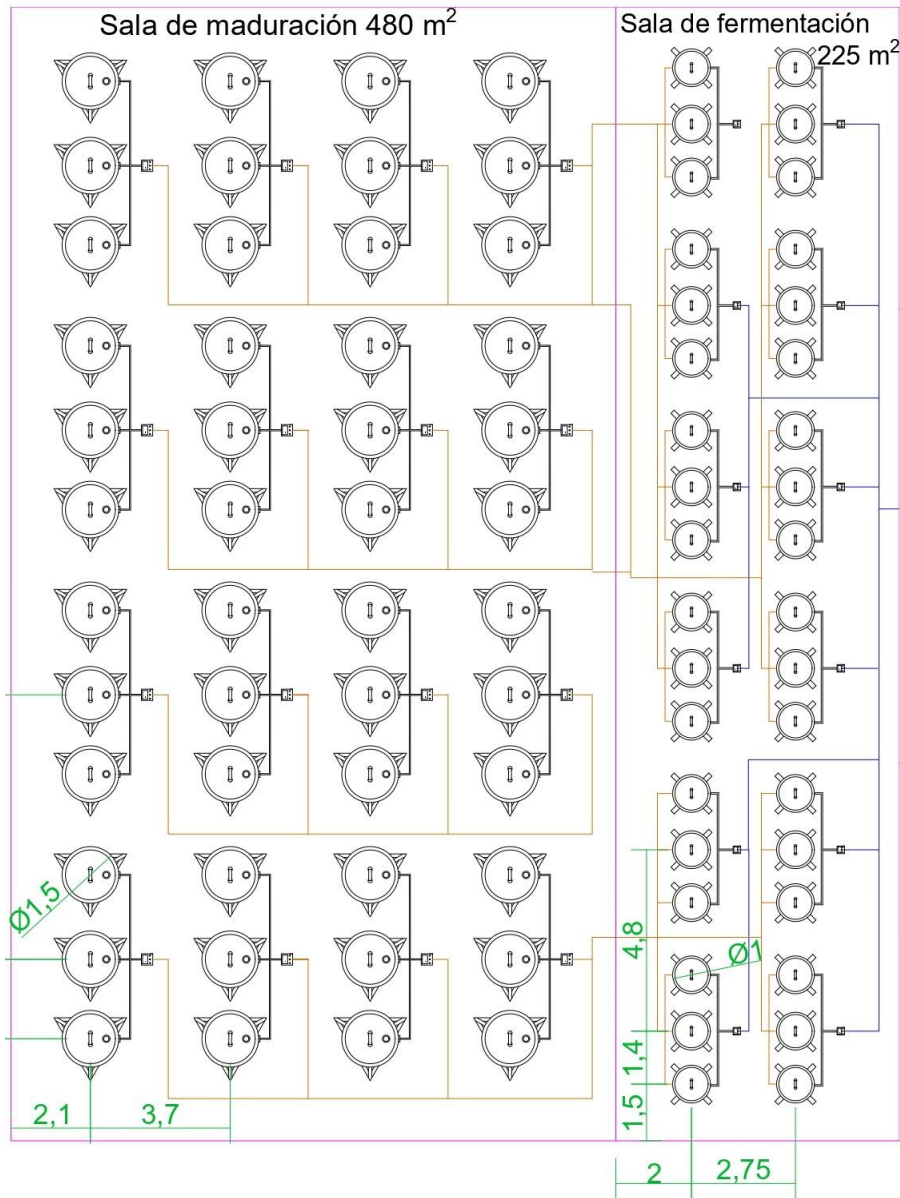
Layout salas de fermentación y de maduración (cotas en metros)
